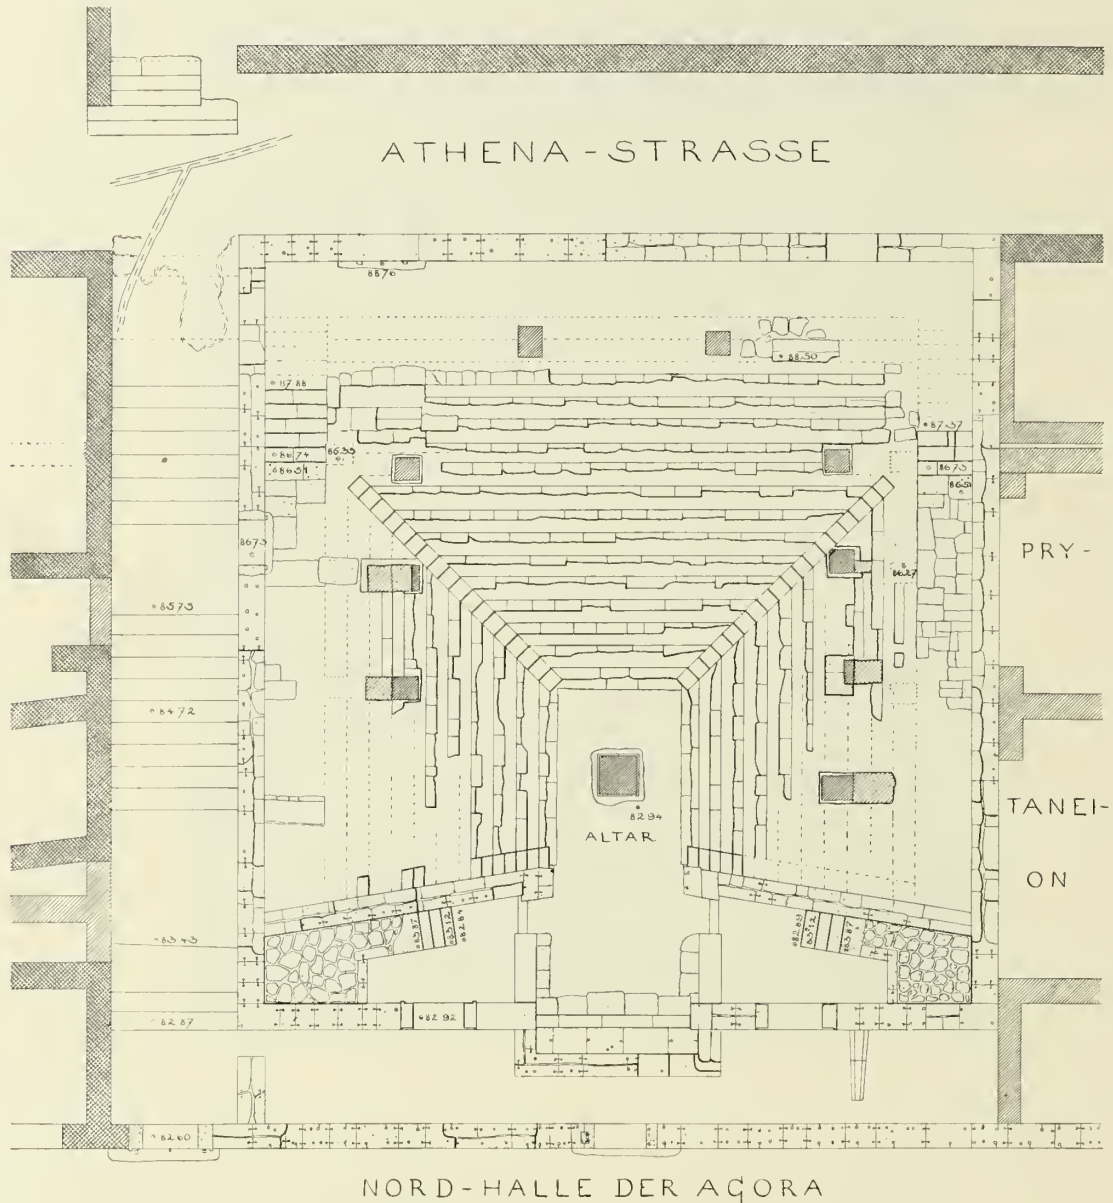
Grundriss des Ekklesiasterion. Erhaltungszustand.
